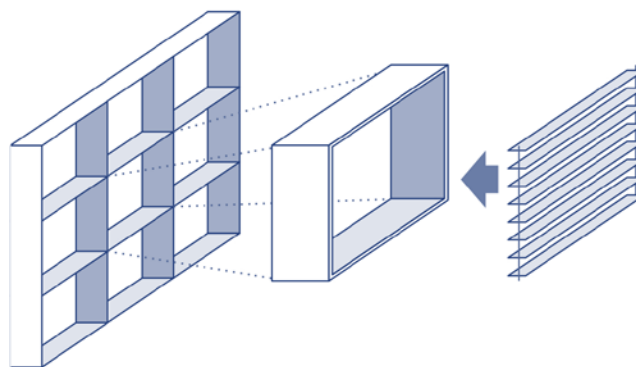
Módulo da estrutura da fachada. Elaborado pelos autores.
